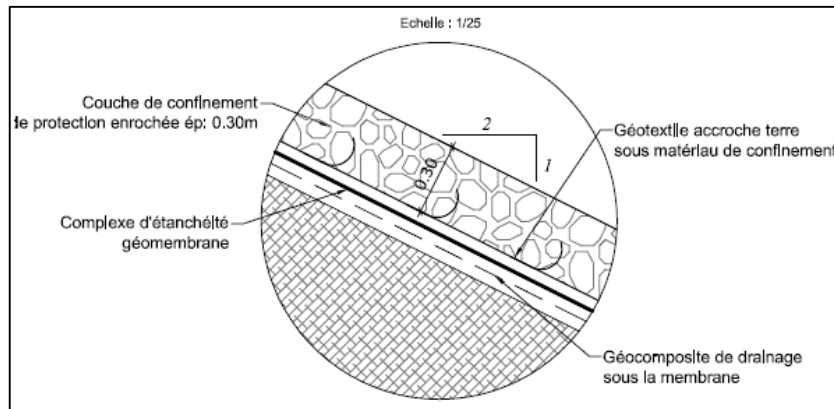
Détail du complexe d'étanchéité des berges dans la zone de plan d'eau permanent
